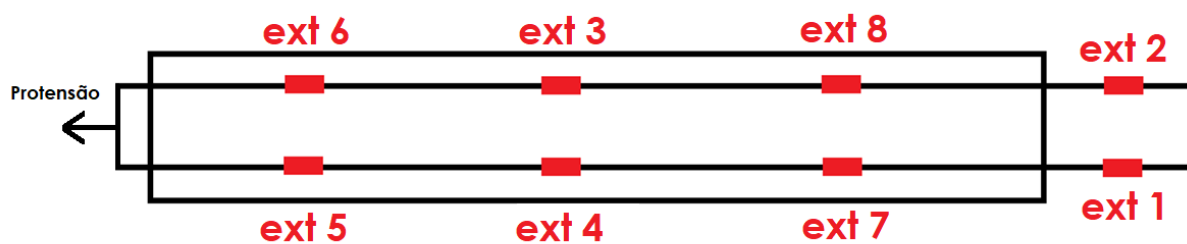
Localização dos extensômetros na barras de basalto nas viga 1 e na viga 2
